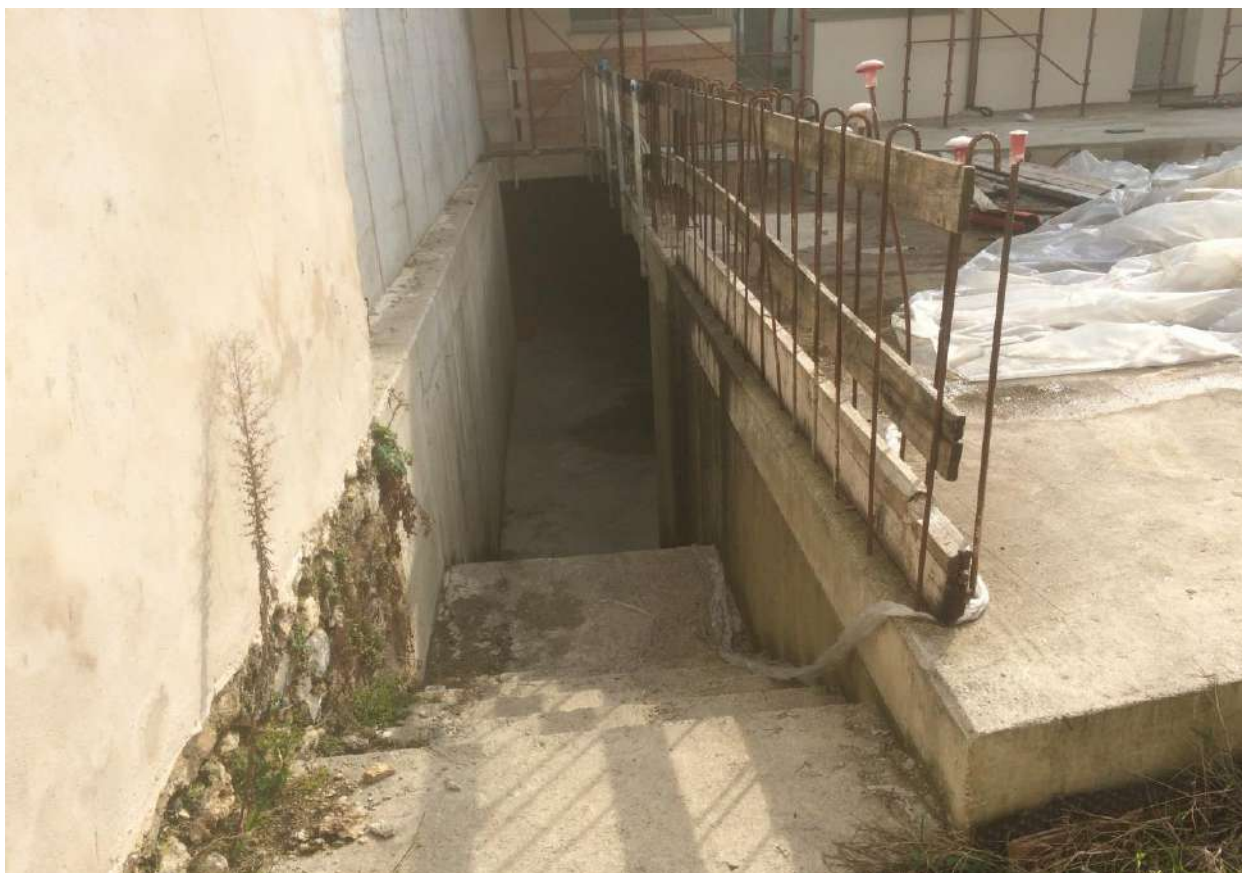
PARTICOLARE SOLAIO VOLTATO
